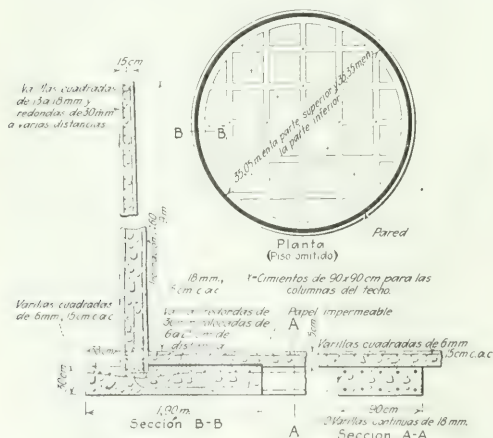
DETALLES DEL DEPÓSITO DE HORMIGÓN
